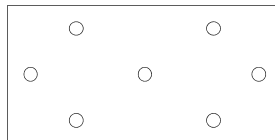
Plans de chevillage - panneaux de dimensions 1000 x 500 mm
